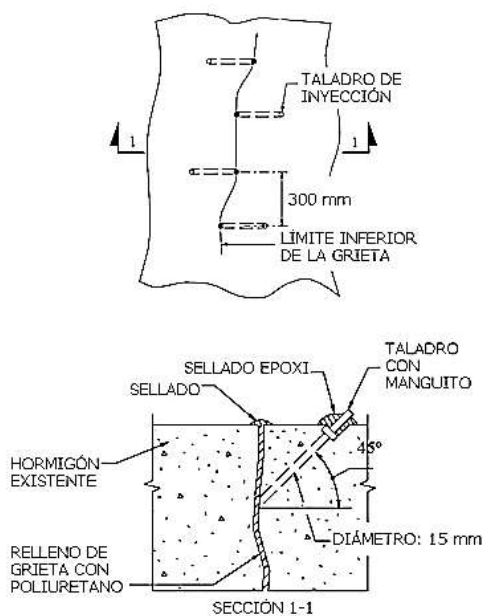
Detalle constructivo de sellado Epoxi de grieta
